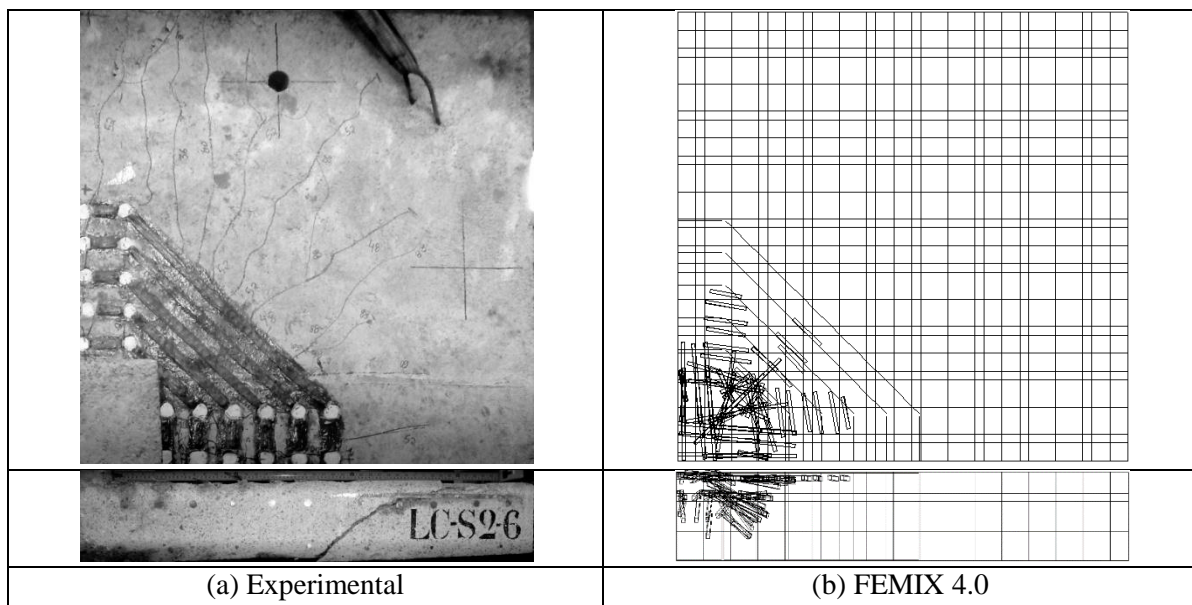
Padrão de fissuração - LC-S2-6 (FEMIX 4.0)
